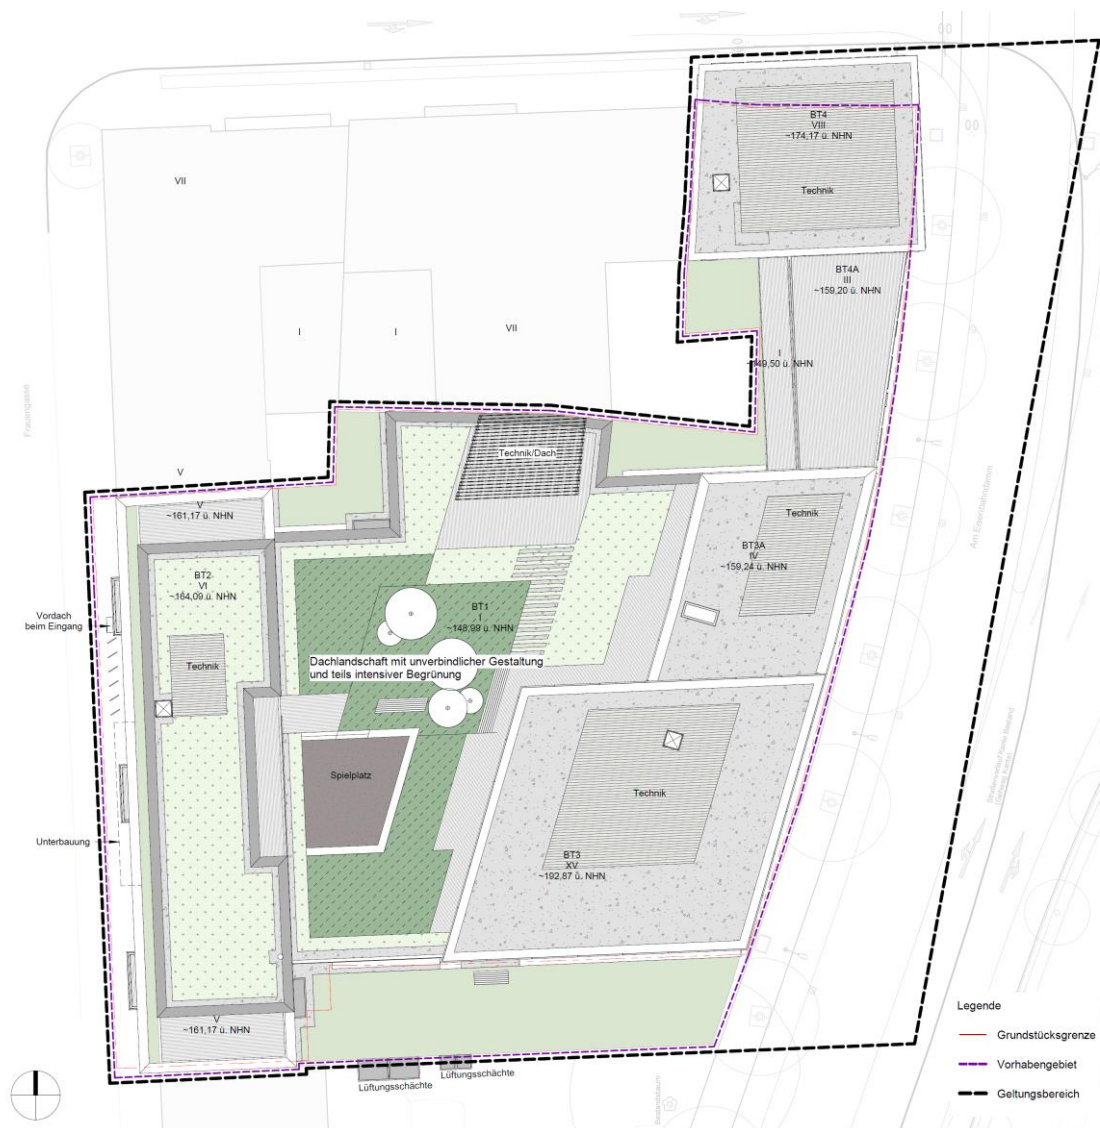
Lageplan „Quartier 22“, AS+P, 2025
